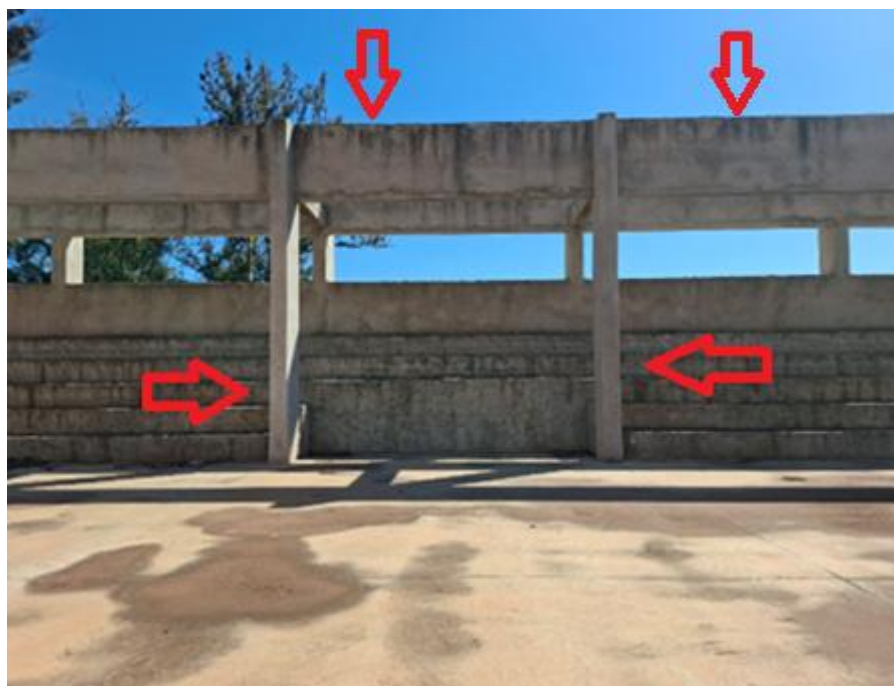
vista geral do lado esquerdo – pilares com projeção e viga no espaço da quadra e arquibancada
